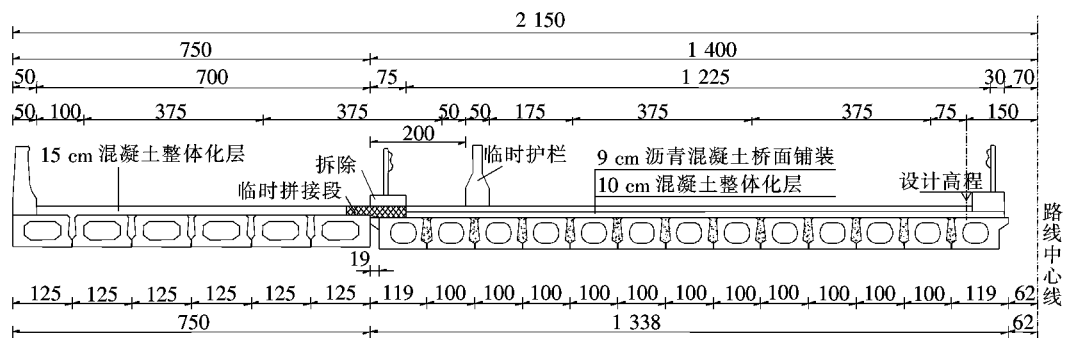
10、13、16、20 m 空心板临时拼接横断面示意图(单位:cm)
